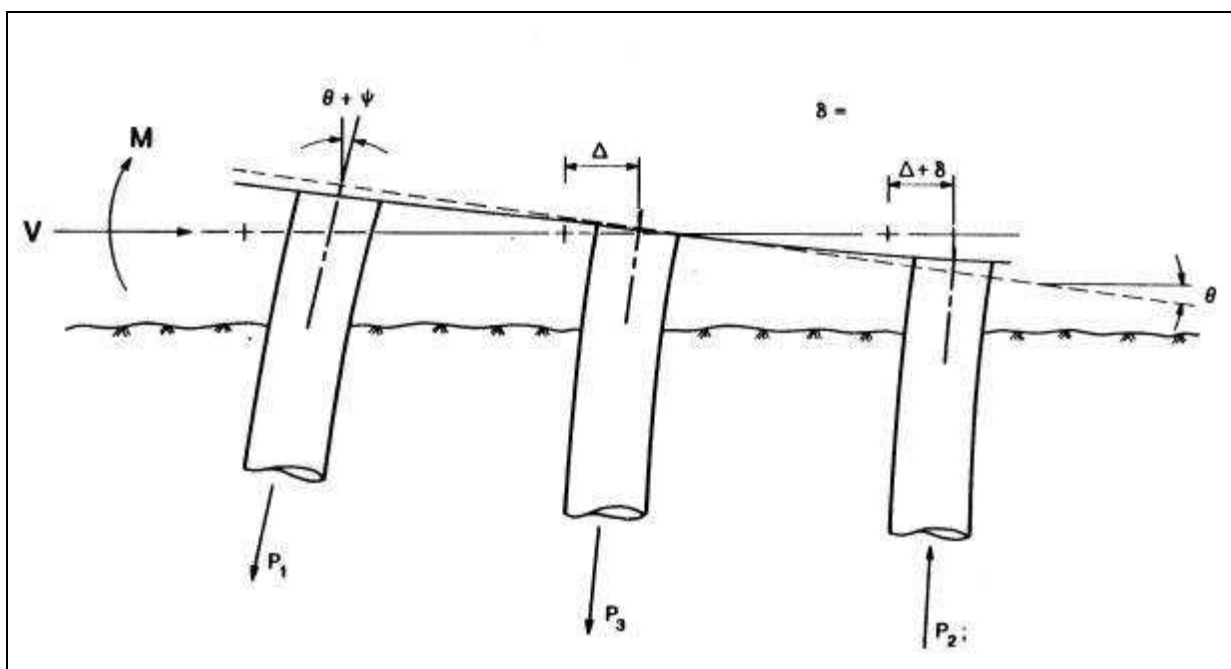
Comportement d'un groupe de pieux verticaux sous chargement transversal. [O'NEILL & al., 1985]
